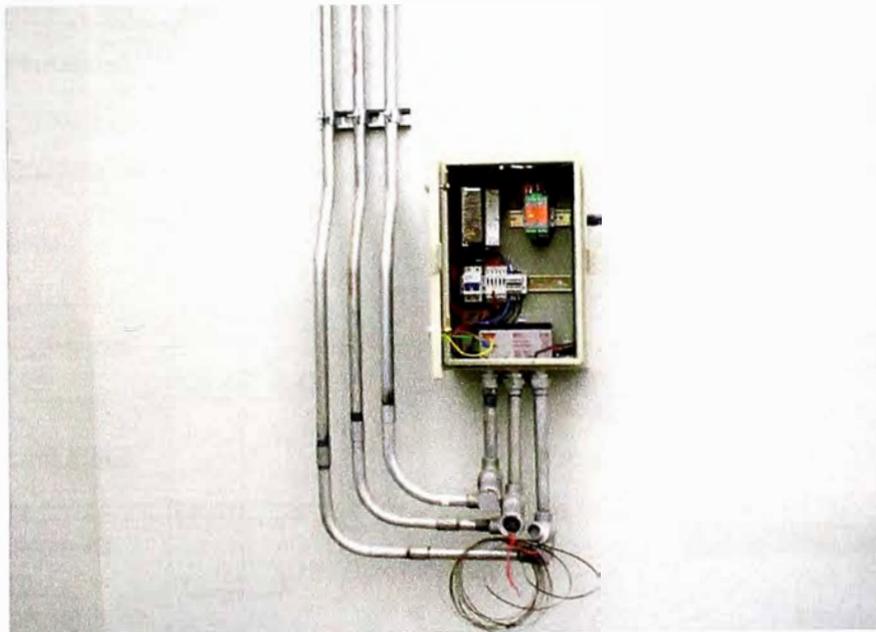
Módulo GSM/GPRS emplazado externamente al ERM
